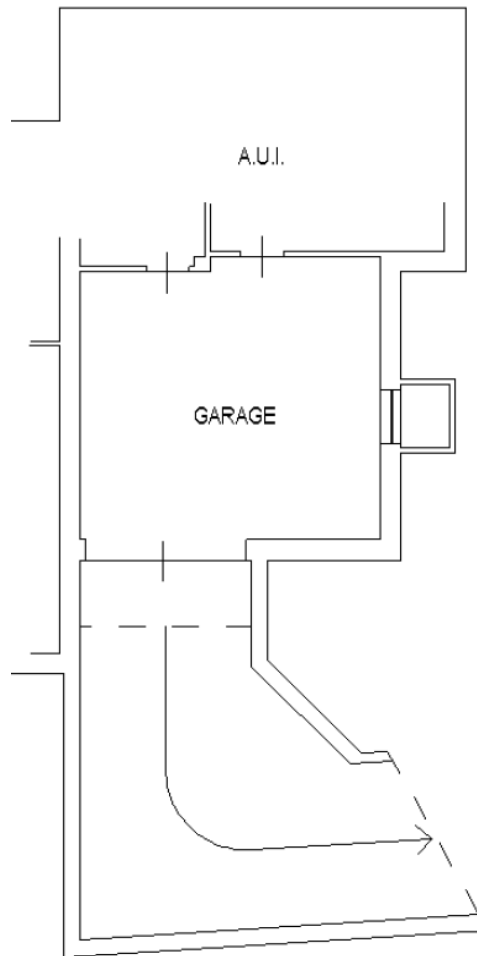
Estratto della planimetria catastale – sub. 4, p.int.
